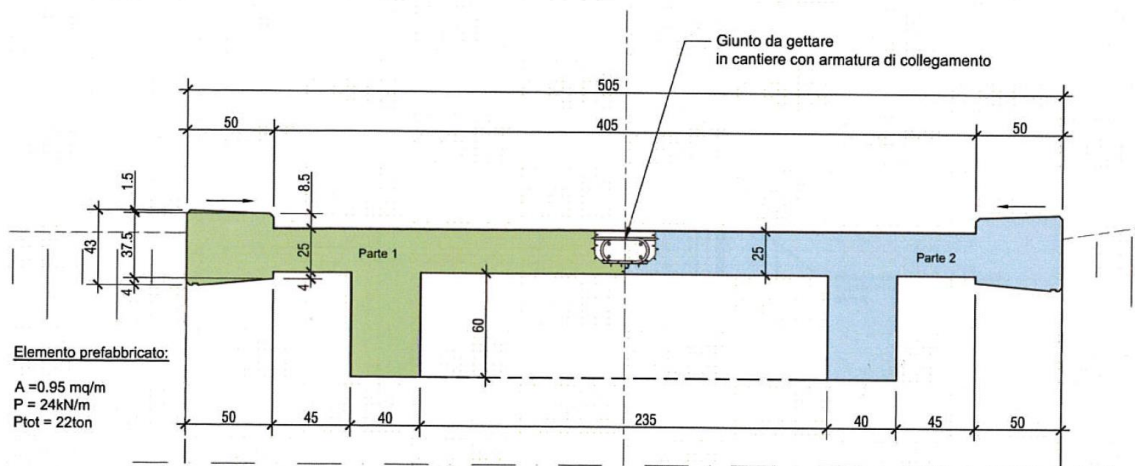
Progetto – sezione trasversale elementi prefabbricati
